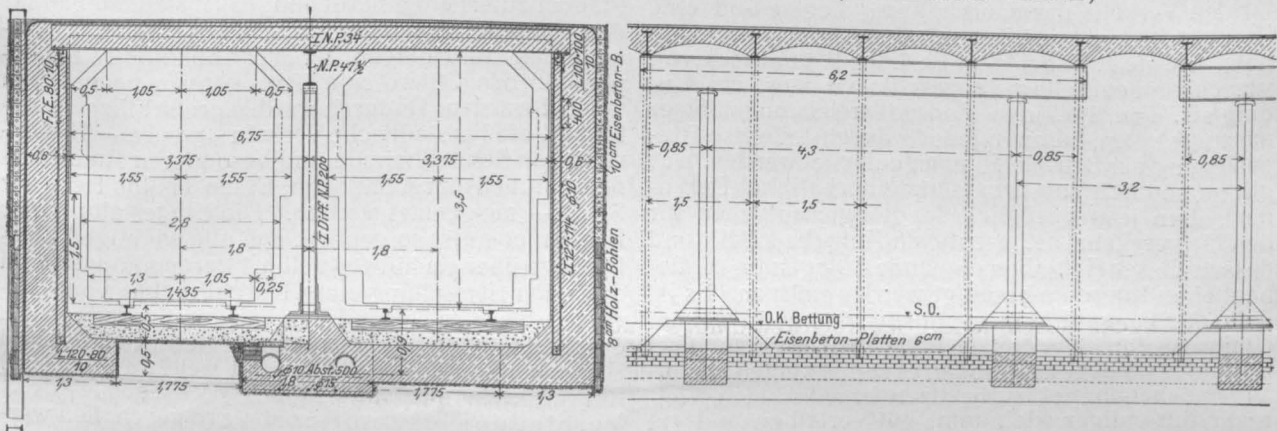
und b. Tunnelstrecke mit offener Sohle und Quersteinen.
